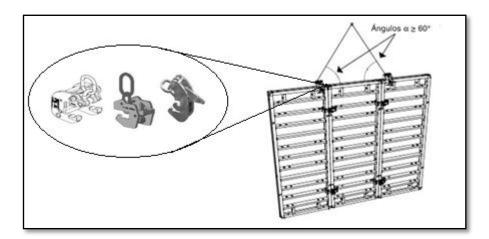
Levantamiento de paneles mediante eslingas y ganchos
